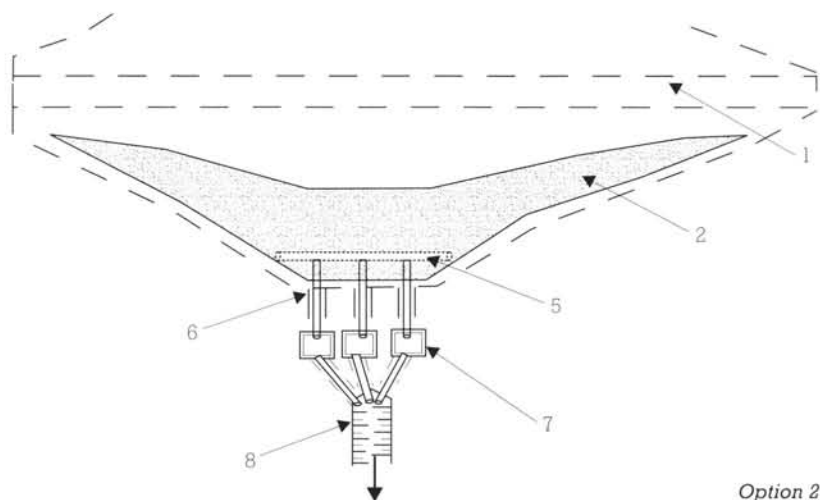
Schémas de principe d'un dispositif drainant dans le cas d'une fondation partiellement perméable.
